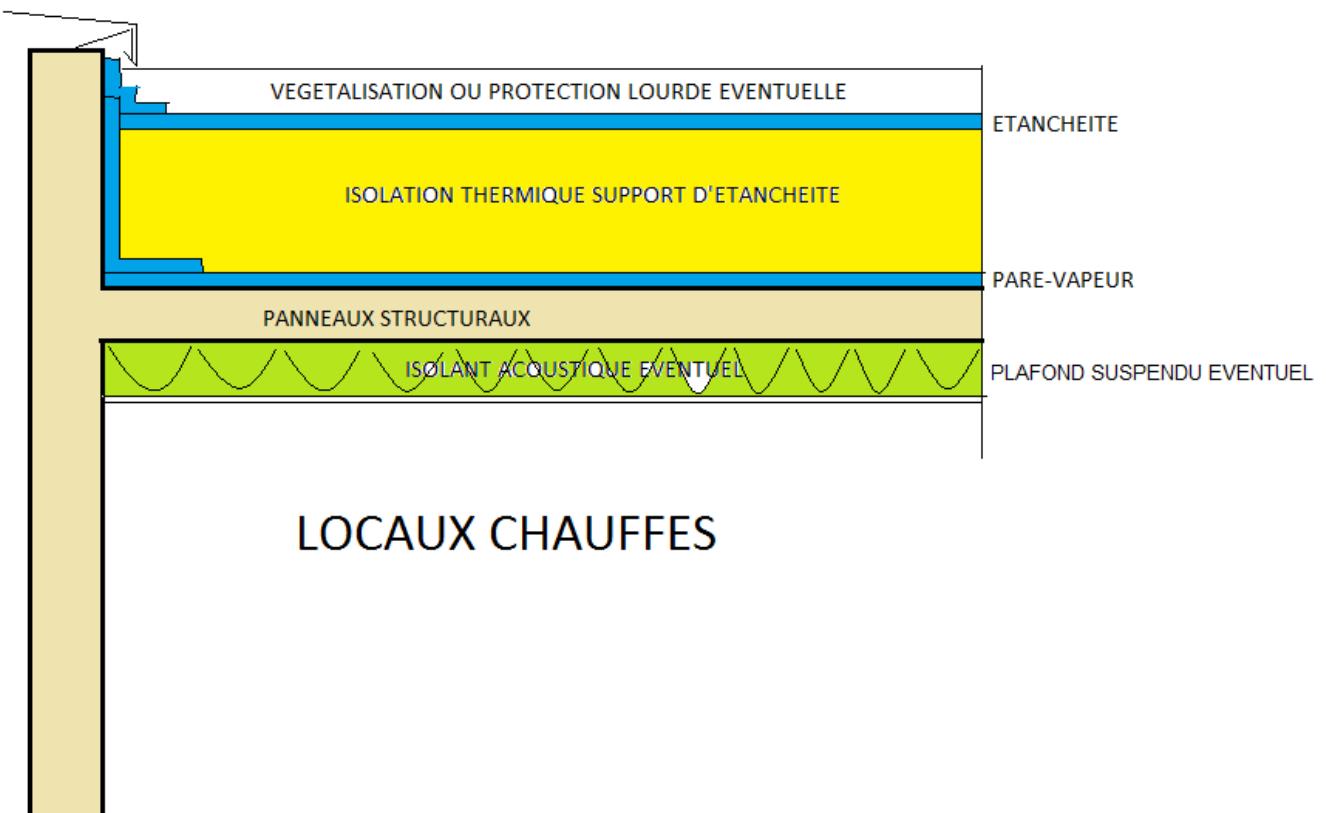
Principe de toitures terrasses inaccessibles, techniques ou végétalisées, avec isolant support d'étanchéité (coupe perpendiculaire à la pente)
